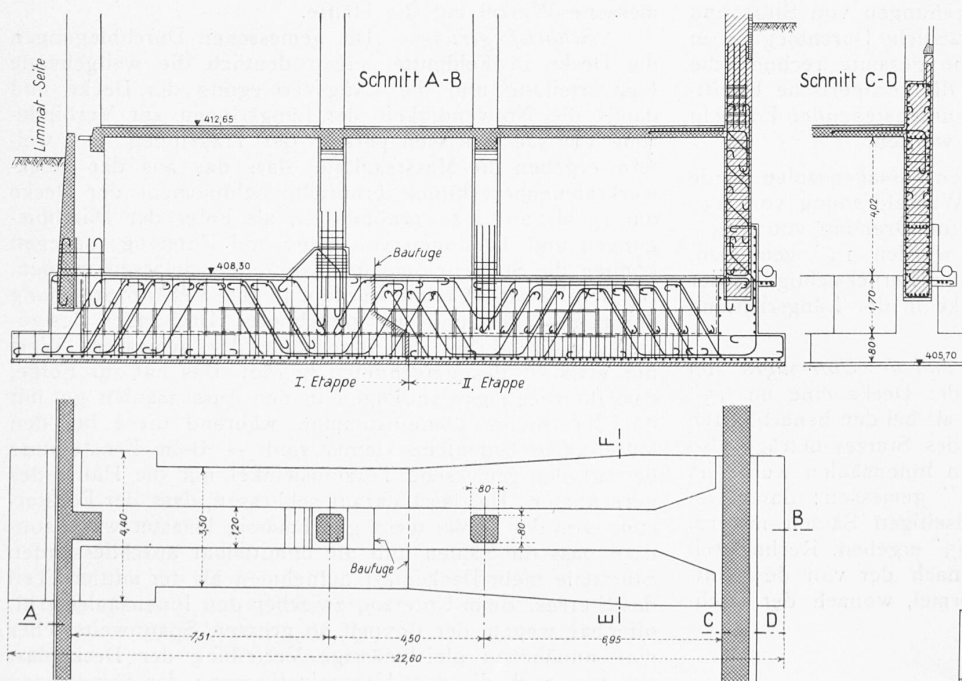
Fundamentschwelle des (untern) Baublocks am Walchequai. — Masstab 1 : 200.
